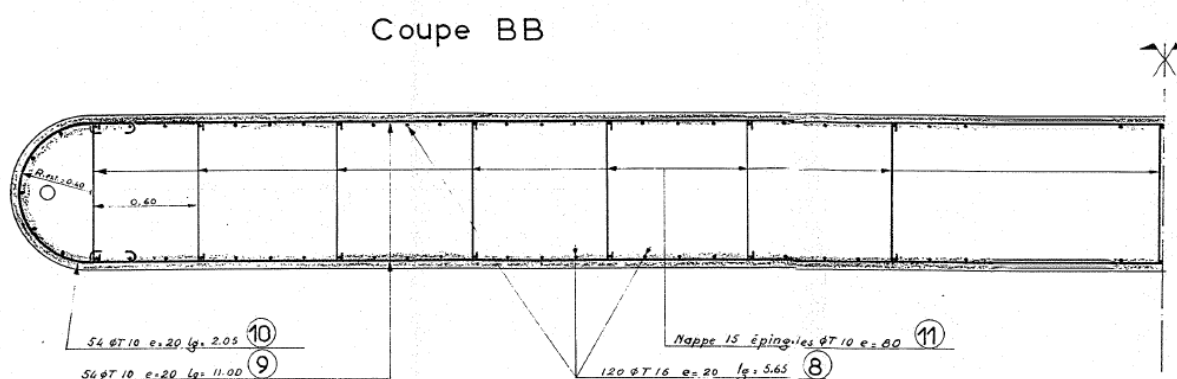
Plan de ferrailage des piles – Coupe longitudinale
